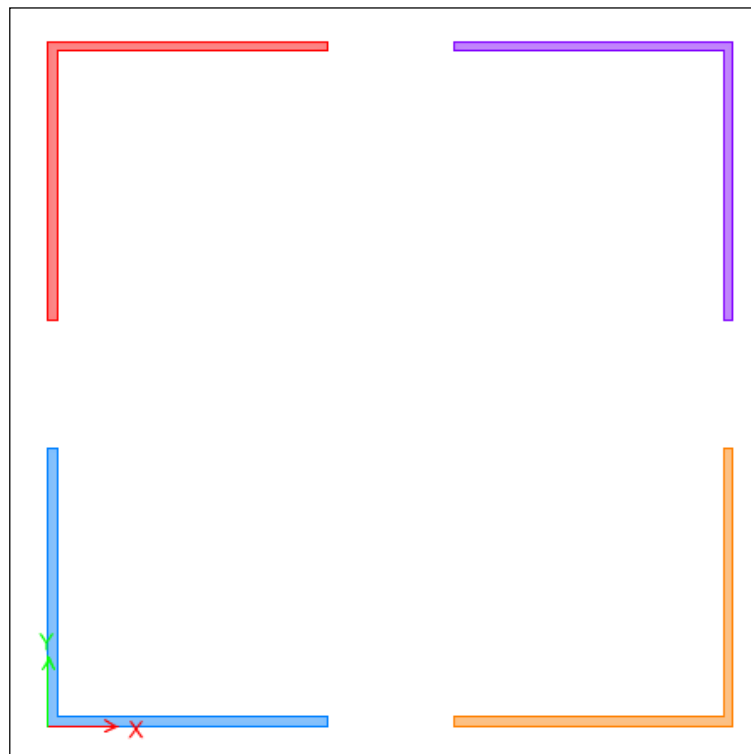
Vista en planta del Edificio A (elementos tipo barra de sección transversal irregular)
